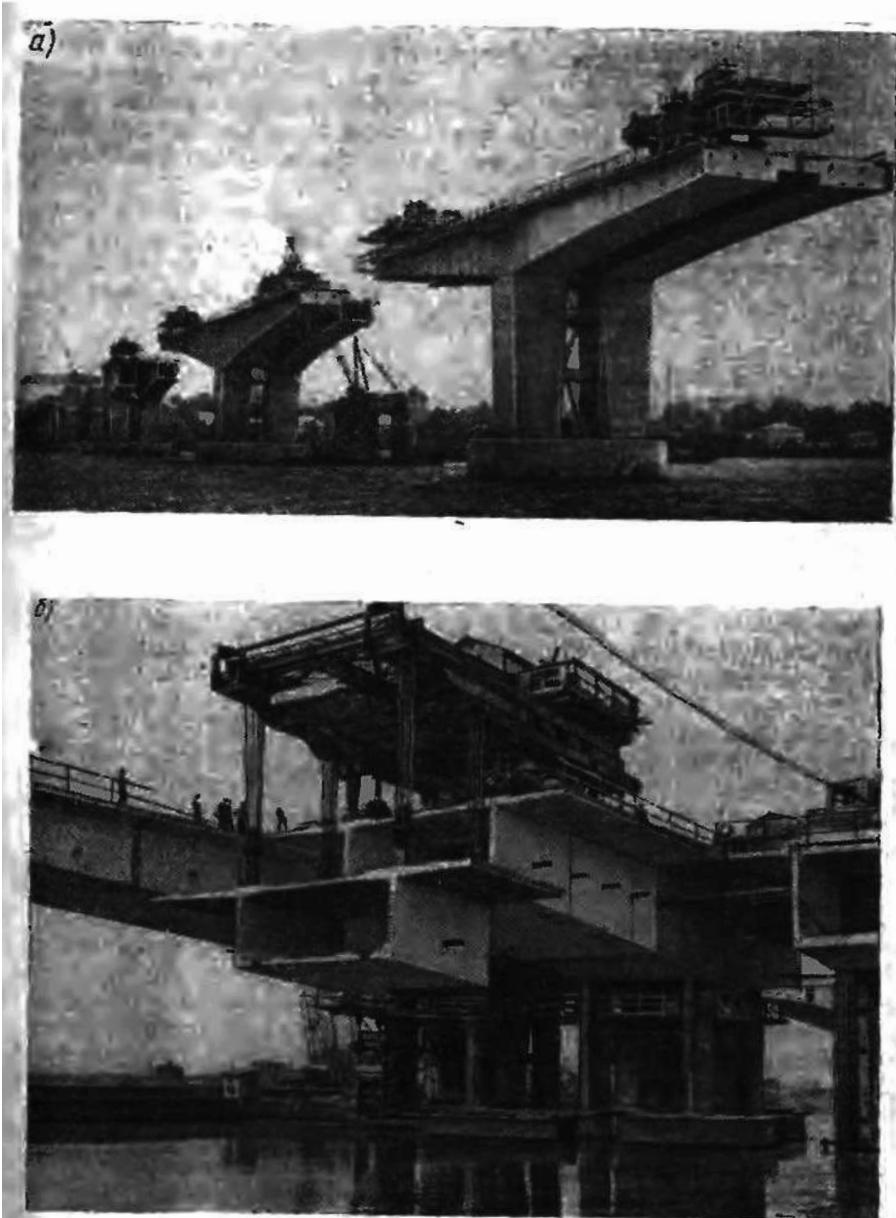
Навесной монтаж железобетонных пролетных строений:
